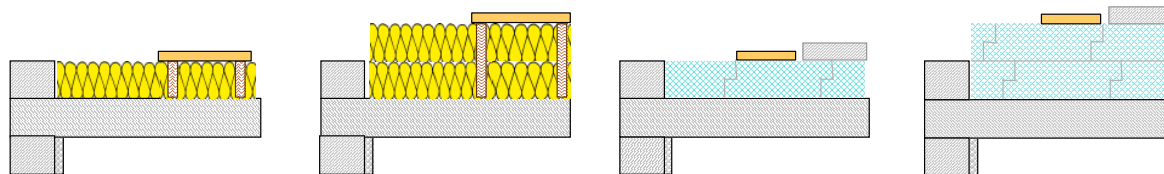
Beton-Kehlbalkendecken, Sanierungsvarianten von oben
